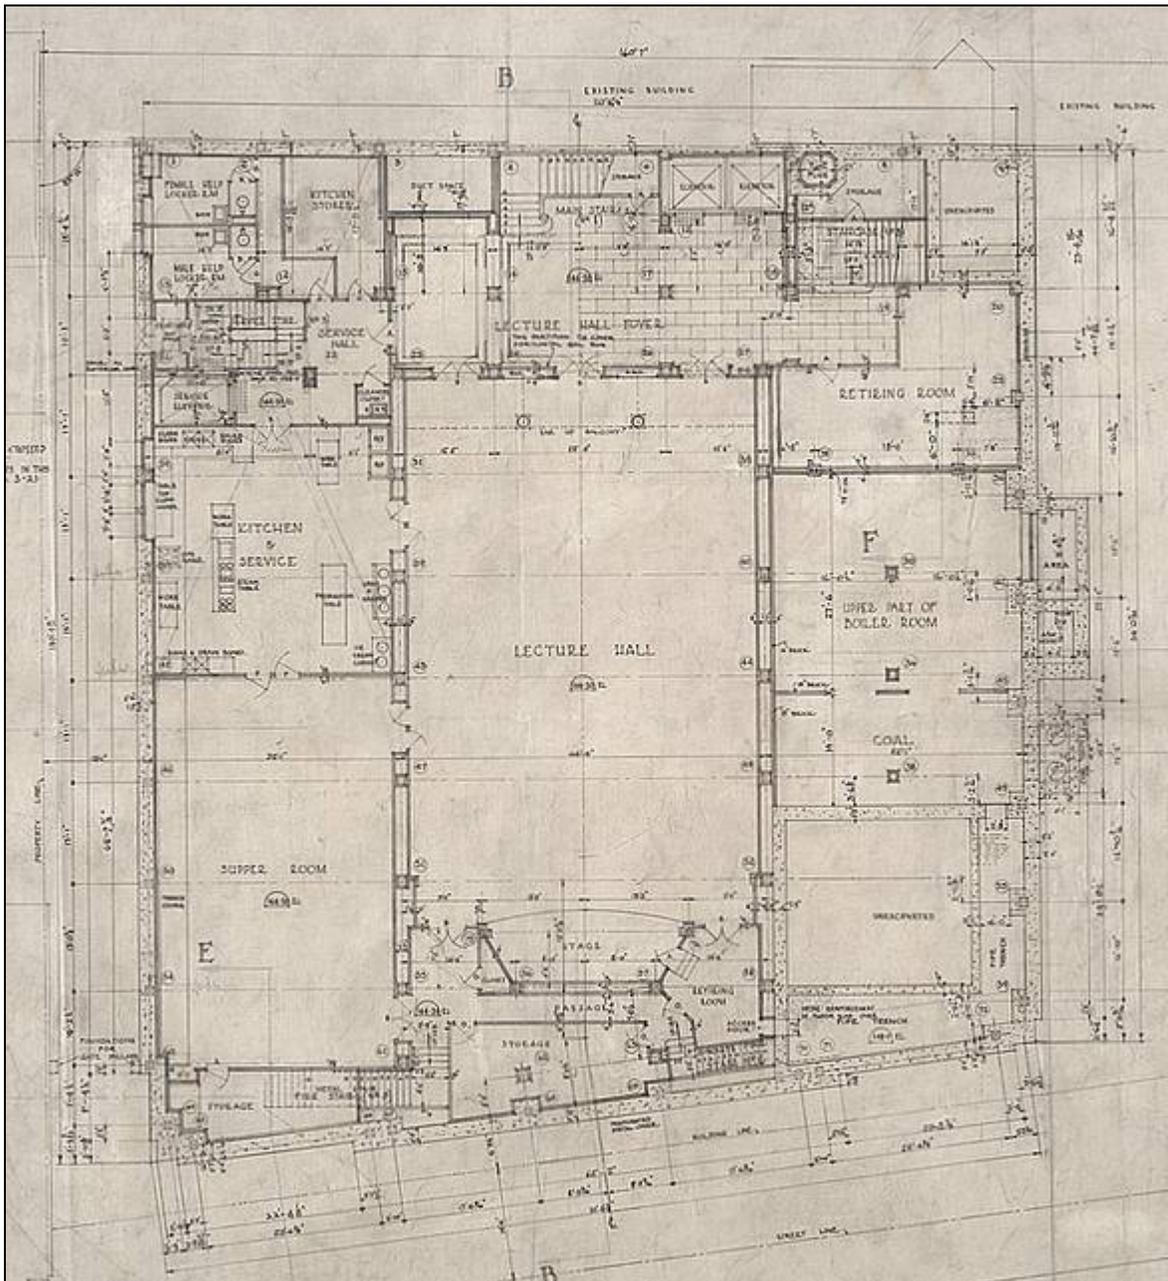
Plan du *basement floor* ou étage n° 1 (détail de la feuille du plan).
